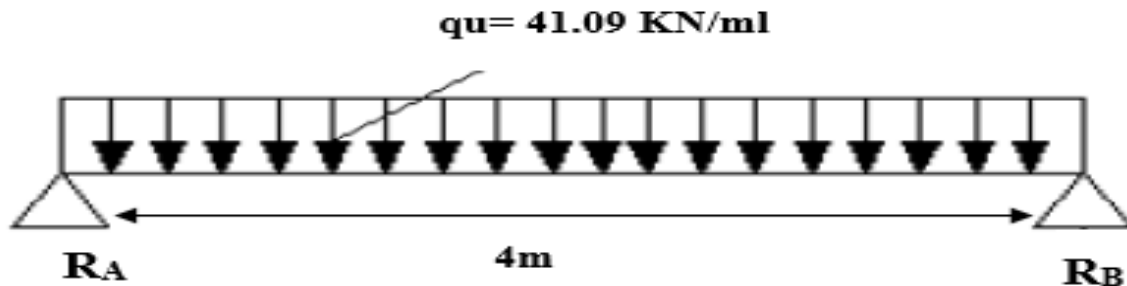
schéma statique de la poutre palière à l'ELS
